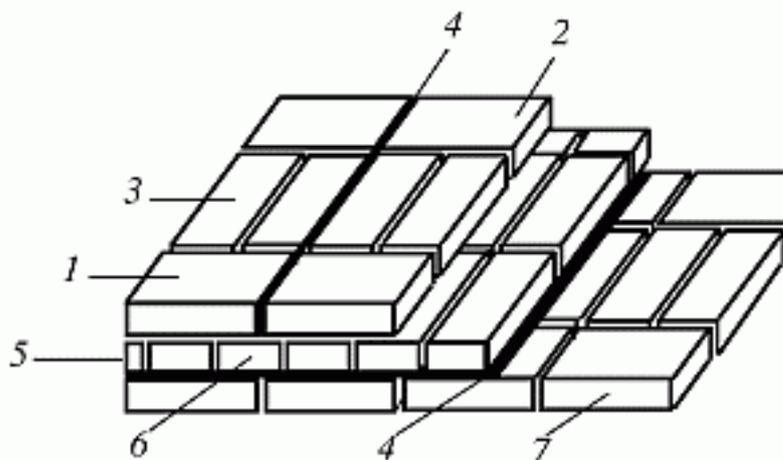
Элементы каменной кладки: 1 – наружная верста; 2 – внутренняя верста; 3 – забутка; 4 – горизонтальный и вертикальный швы; 5 – фасад; 6 – тычковый ряд; 7 – ложковый ряд
